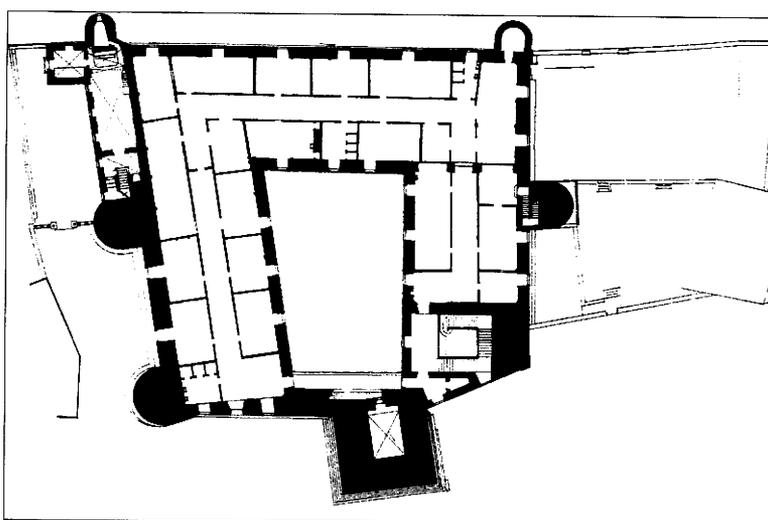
Planta do 1º piso antes das obras de adaptação a pousada
